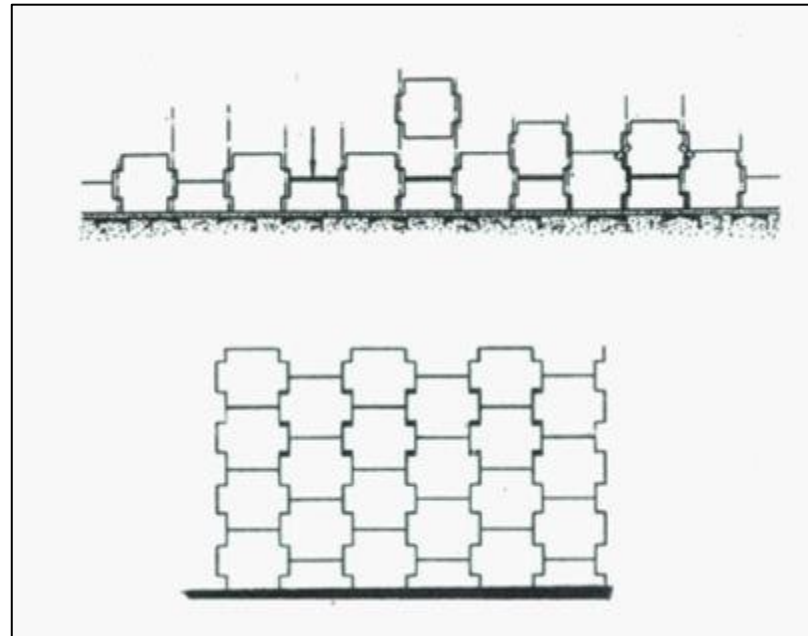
Muro de tierra reforzada: Muro de escamas prefabricadas de hormigón. Fuente: terexserver.net
